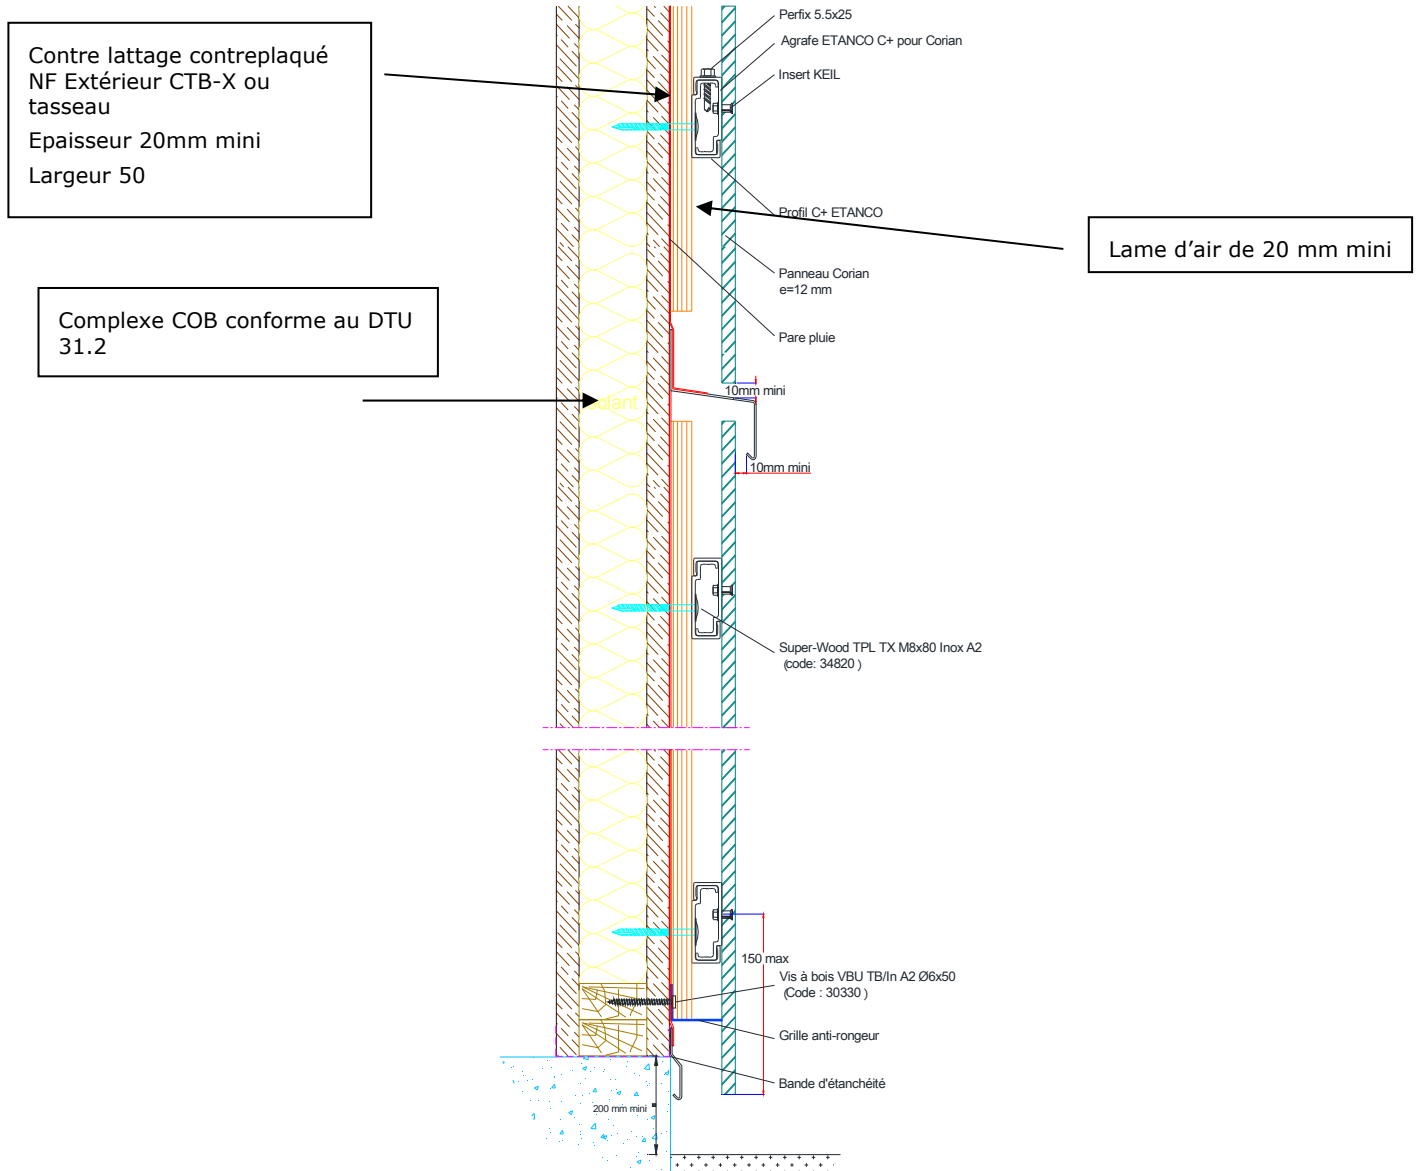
Coupe verticale segmentation lame d'air et part pluie sur COB
